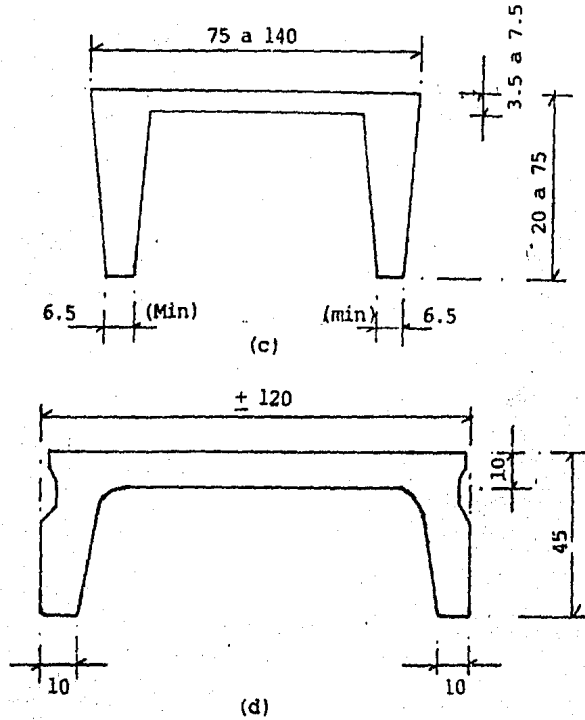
Secciones de concreto postensado que comúnmente se utilizan en edificaciones.
